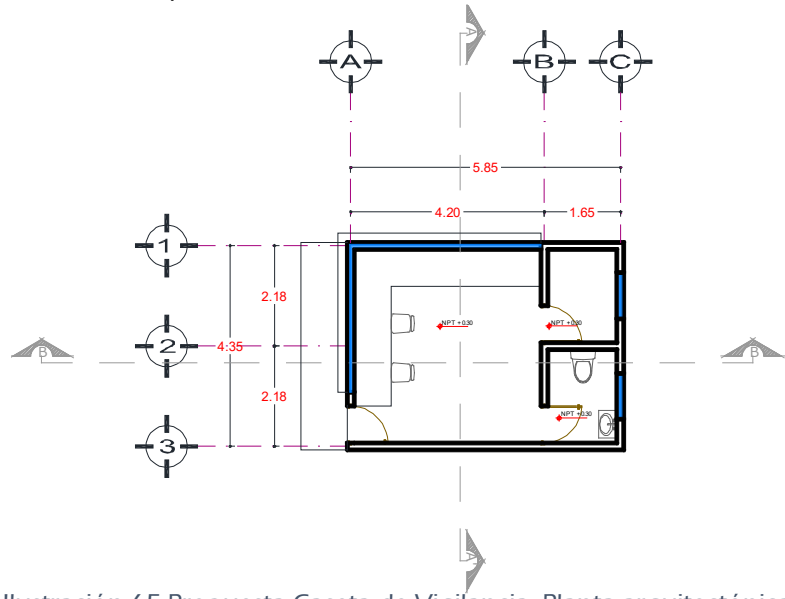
Propuesta Caseta de Vigilancia, Planta arquitectónica (Anexos Plano: 8- CORT-CASETA-01)
